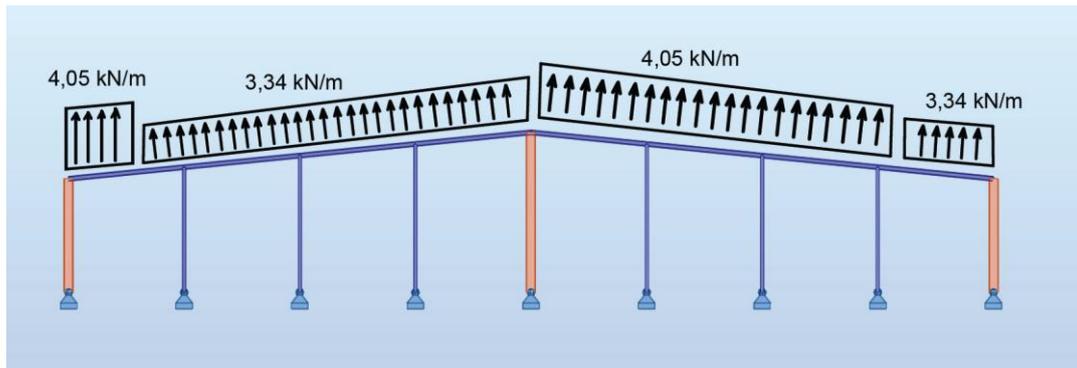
REPRESENTACIÓN COMBINACIÓN ZONAS F+G+F+G EN PÓRTECO DE FACHADA PARA CARGAS CON DIRECCIÓN LONGITUDINAL A CUBIERTA
